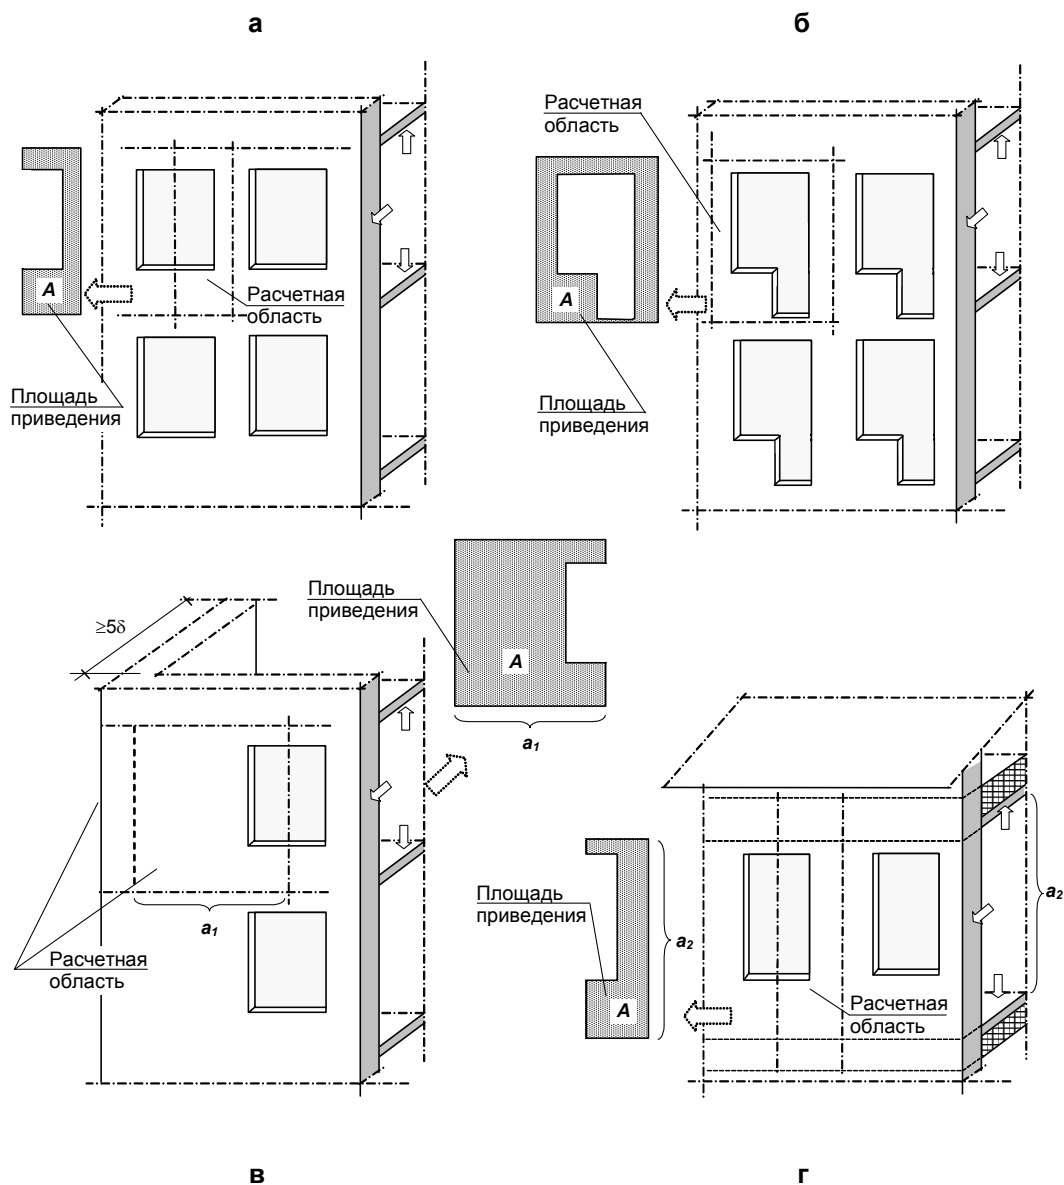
Примеры задания расчетной области для некоторых конструкций: а – стена с окнами; б – стена с балконными дверями; в – стена углового помещения; г – стена одноэтажного здания
